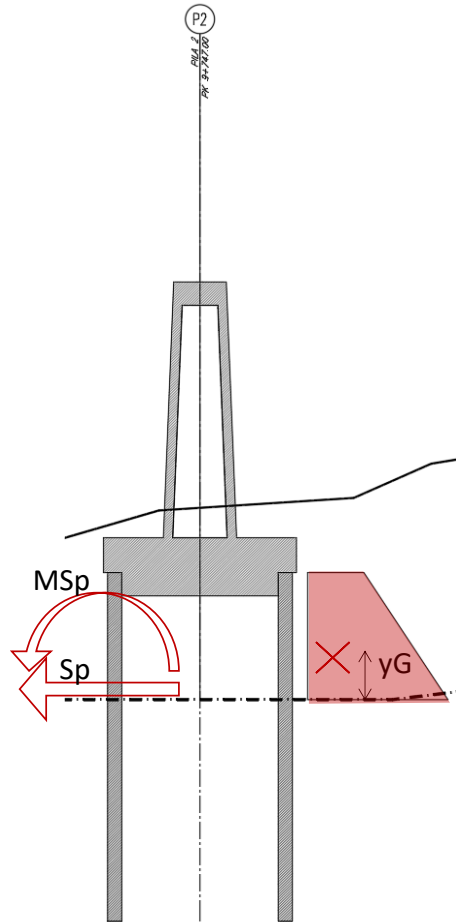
Schema applicazione della spinta delle coltri instabili al pozzo di fondazione
